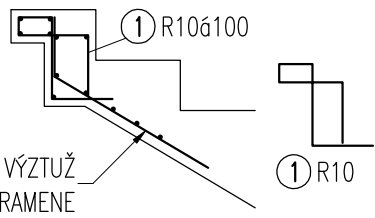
DETAIL VÝZTUŽE OZUBU SCHOD. RAMENE, M 1:25
